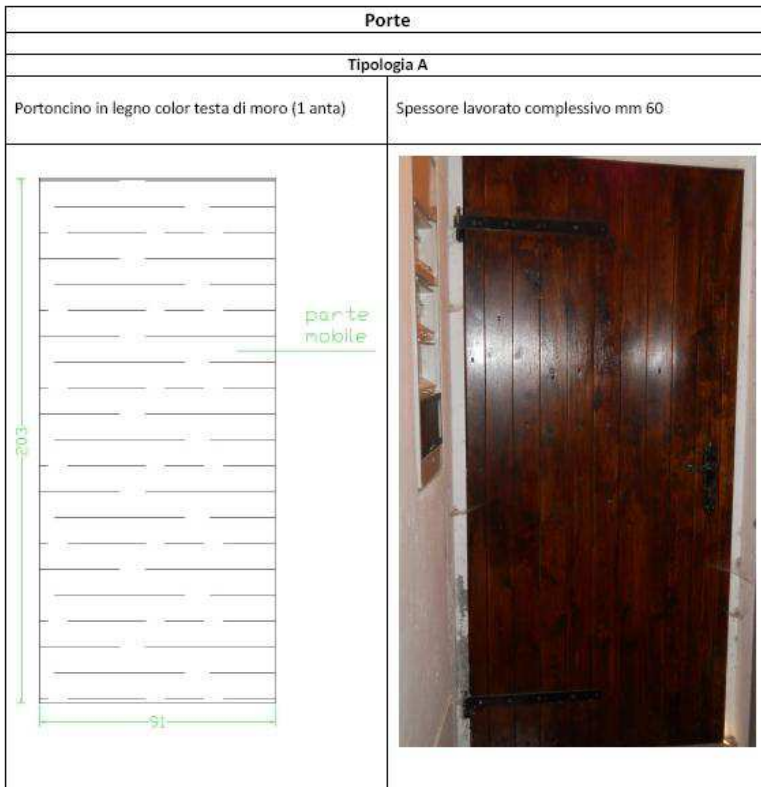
porte esterne di Ca' Soldato
